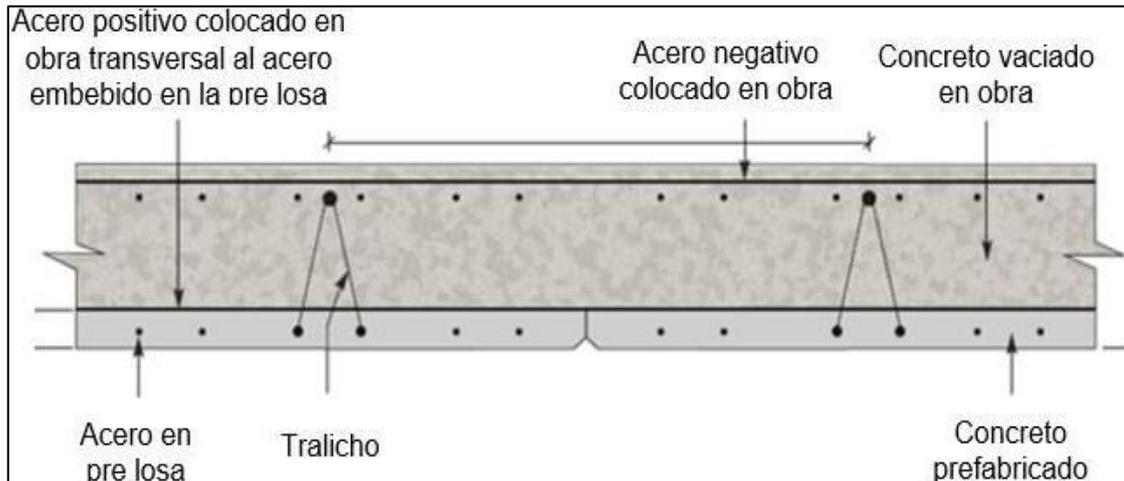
Ejemplo de detalle de losa maciza Prelosa $h=20$ cm.
